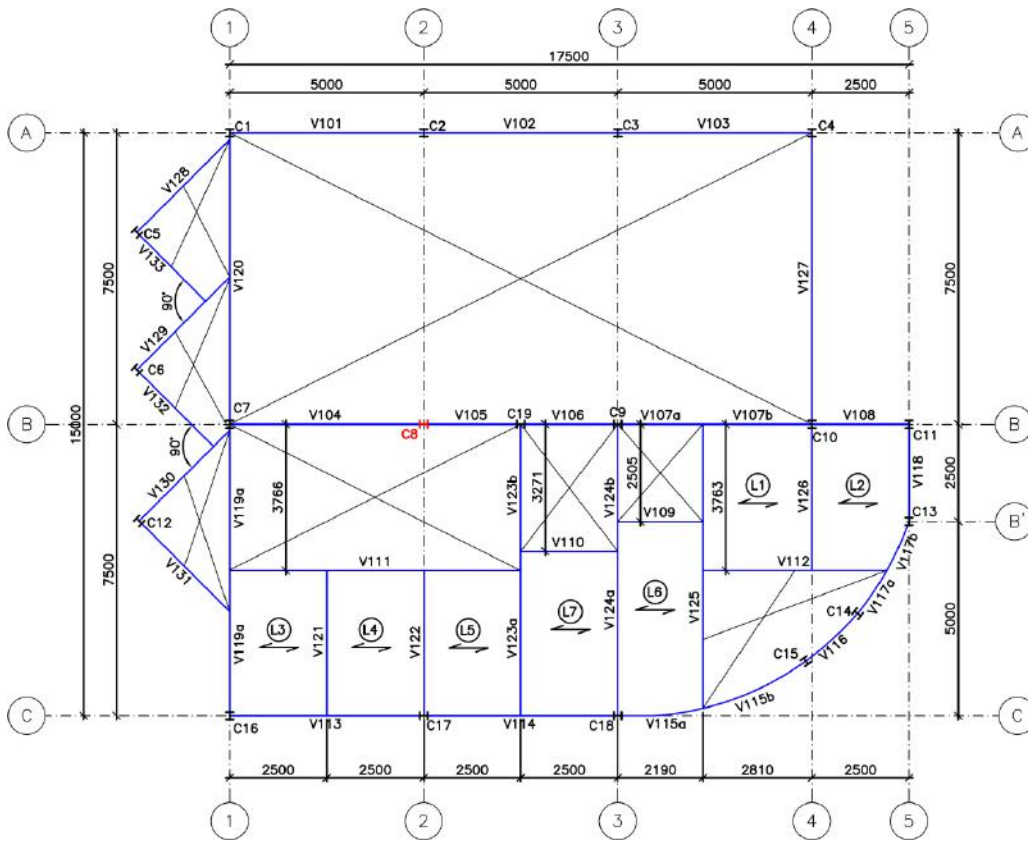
Plano das vigas – EL:+3100mm (Mezanino) – Dimensões em mm
